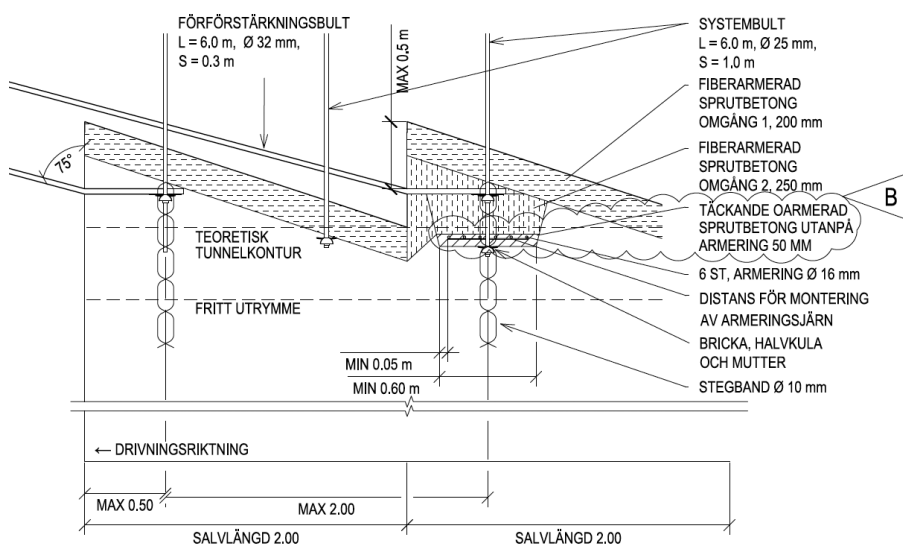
Sprutbetongbågar vid passage under Gårdatunneln (Johansson, 2023).
